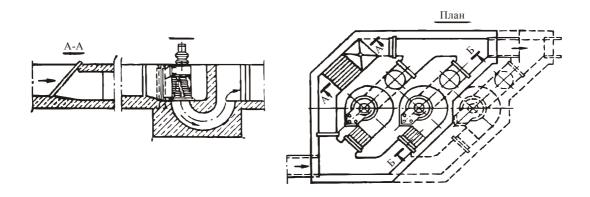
Схема установки решетки-дробилки и резервной наклонной решетки
